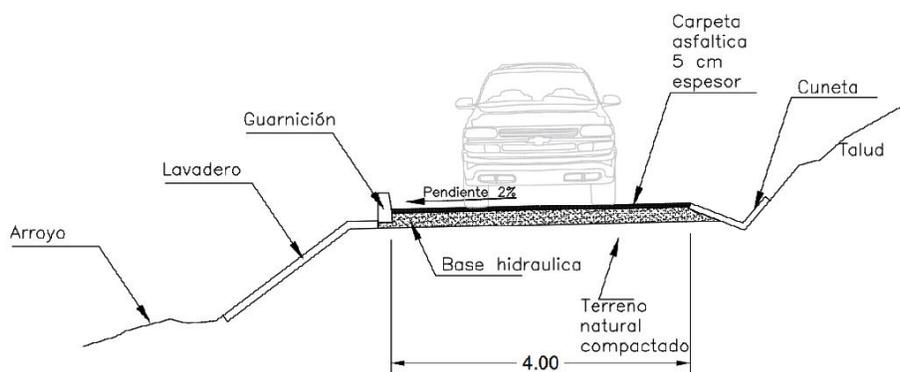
Esquema de pavimentación de las Vialidades internas del proyecto “Montañas del Mar”.
